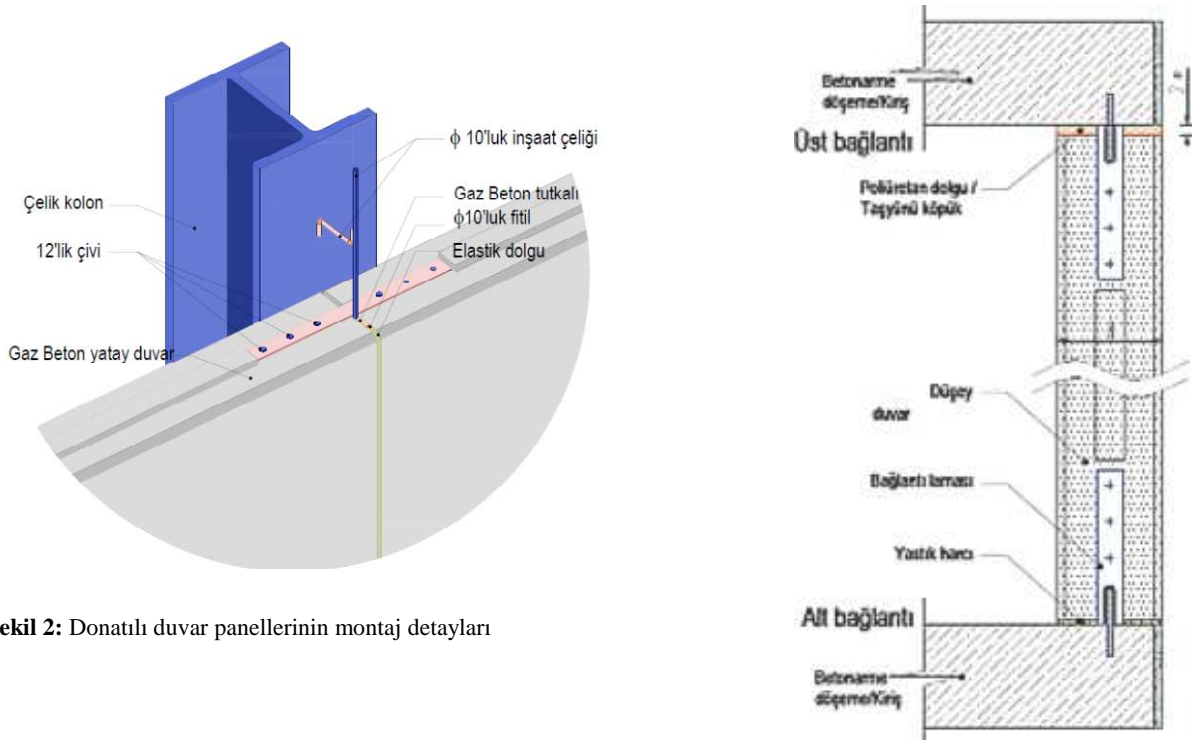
Donatılı Gazbeton Duvar Panellerinde Kullanılan Örnek Montaj Elemanları
